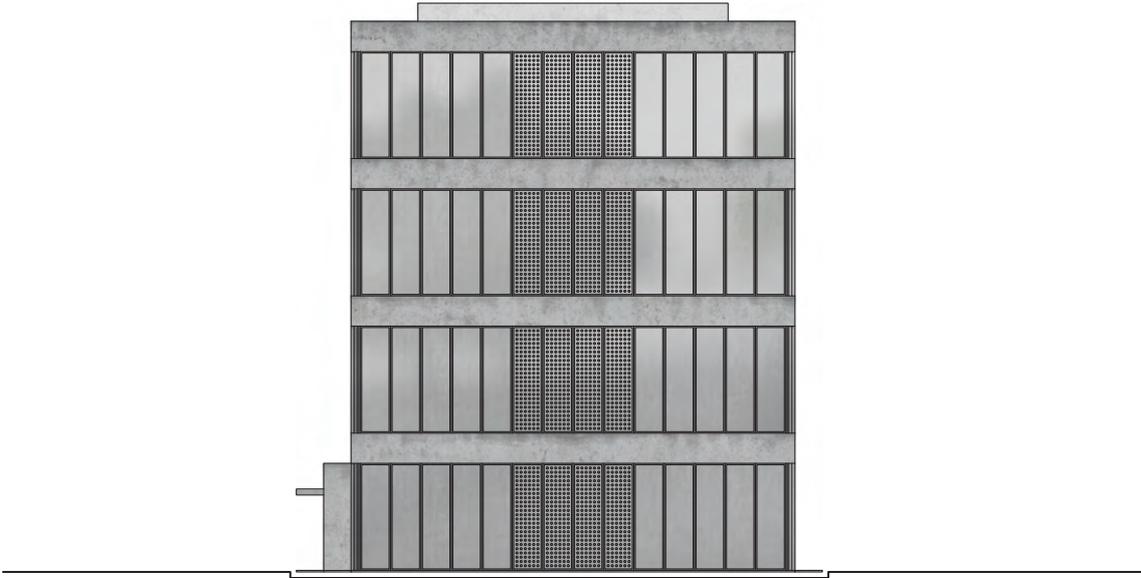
Büroturm Ansicht 2 - geschlossene Fassadenpaneele
